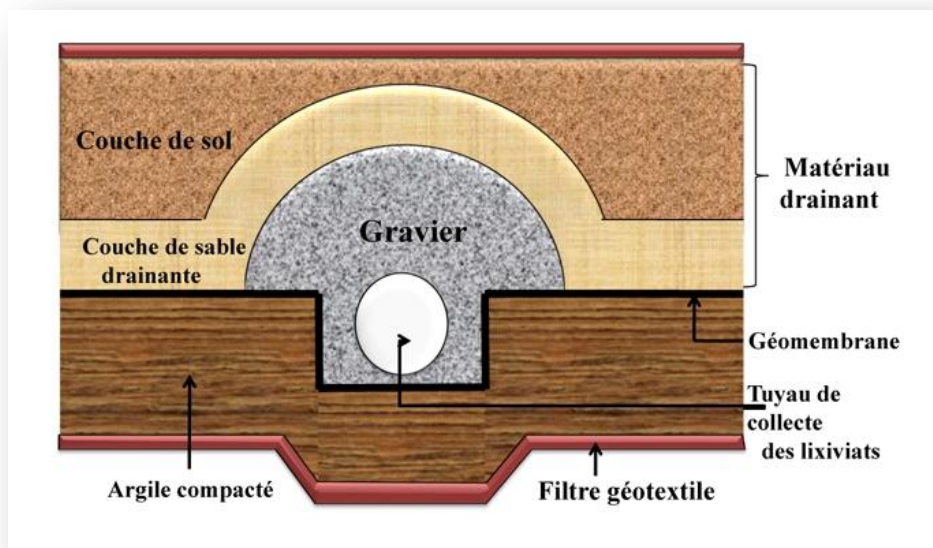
Dispositif de drainage sanitaire de lixiviat
